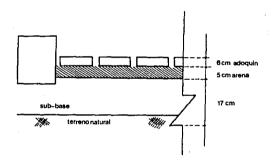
VISTA DE LA SECCION TRANSVERSAL TIPICA DEL PAVIMENTO PARA EL CONJUNTO CONDOMINAL FUENTES DE ATLACOMULCO.
